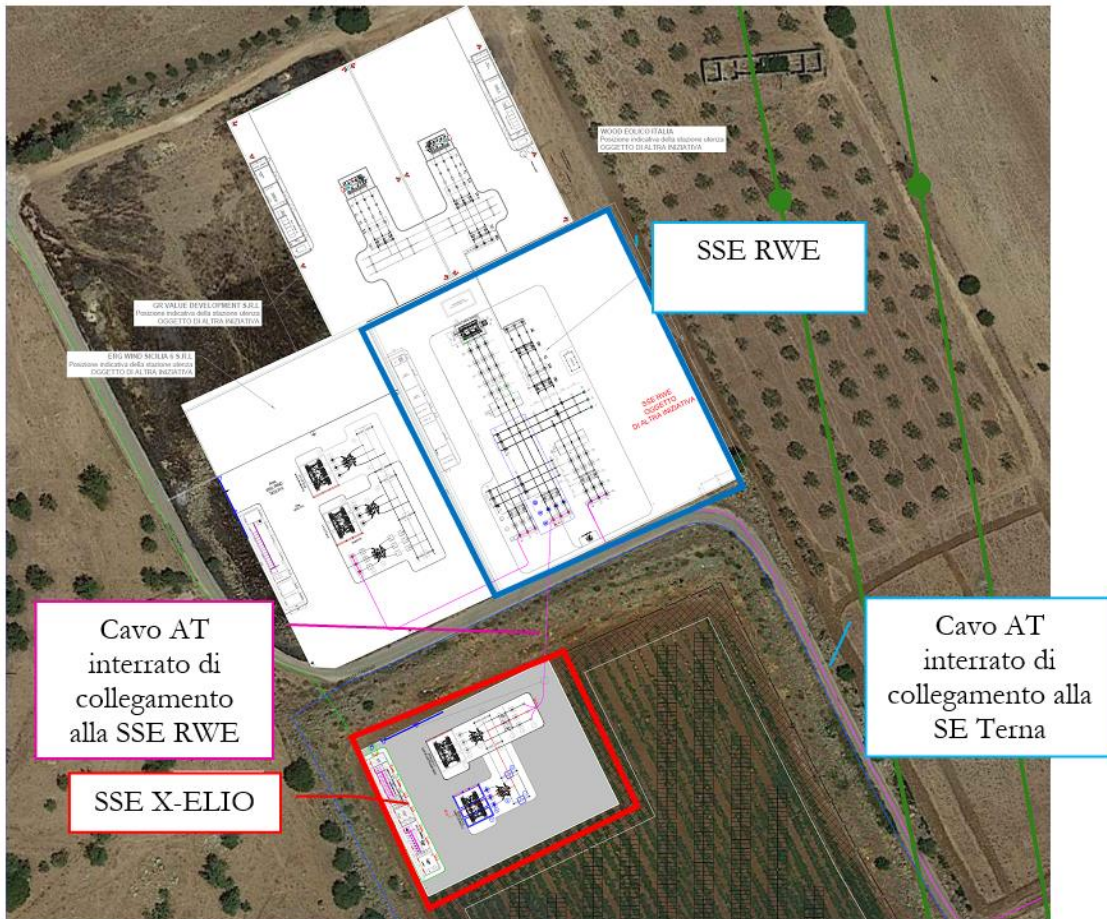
Planimetria con individuazione nuova SSE e elettrodotto AT di collegamento alla SE Terna esistente
